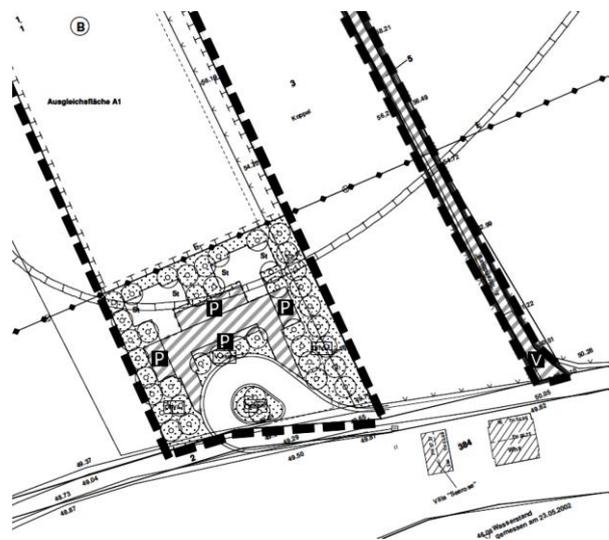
Anschluss Bebauungsplan Nr. 2/2002 „Strandburg“, Ausschnitt ohne Maßstab
